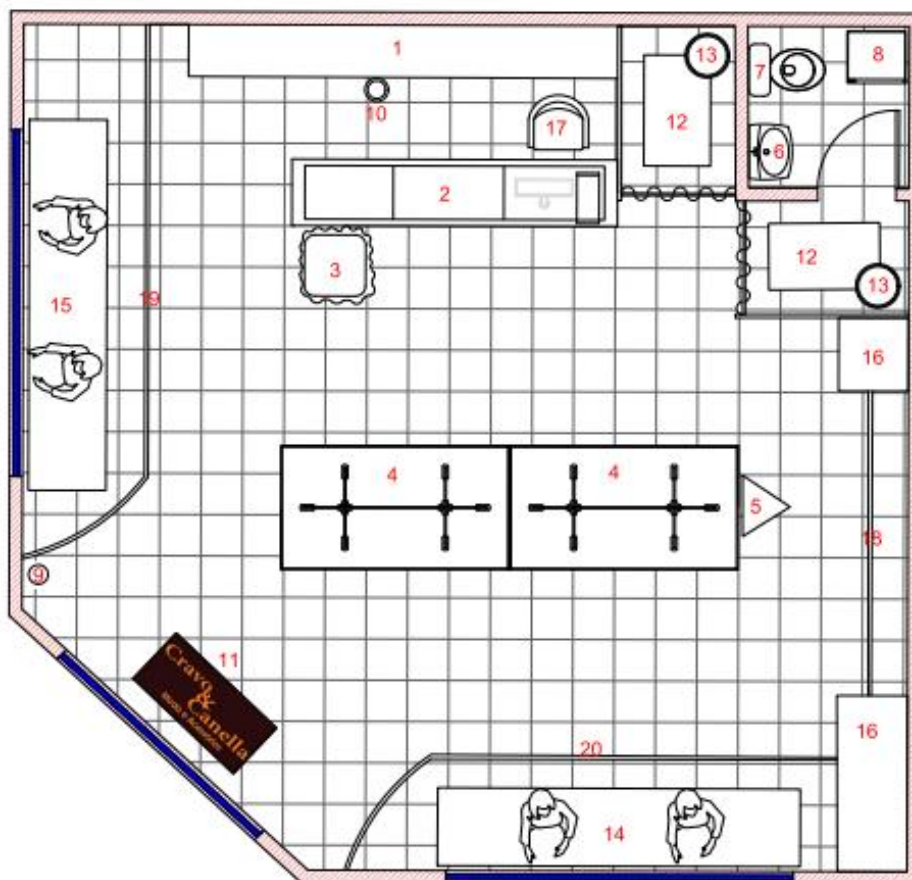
PLANTA BAIXA DA CRAVO & CANELLA
